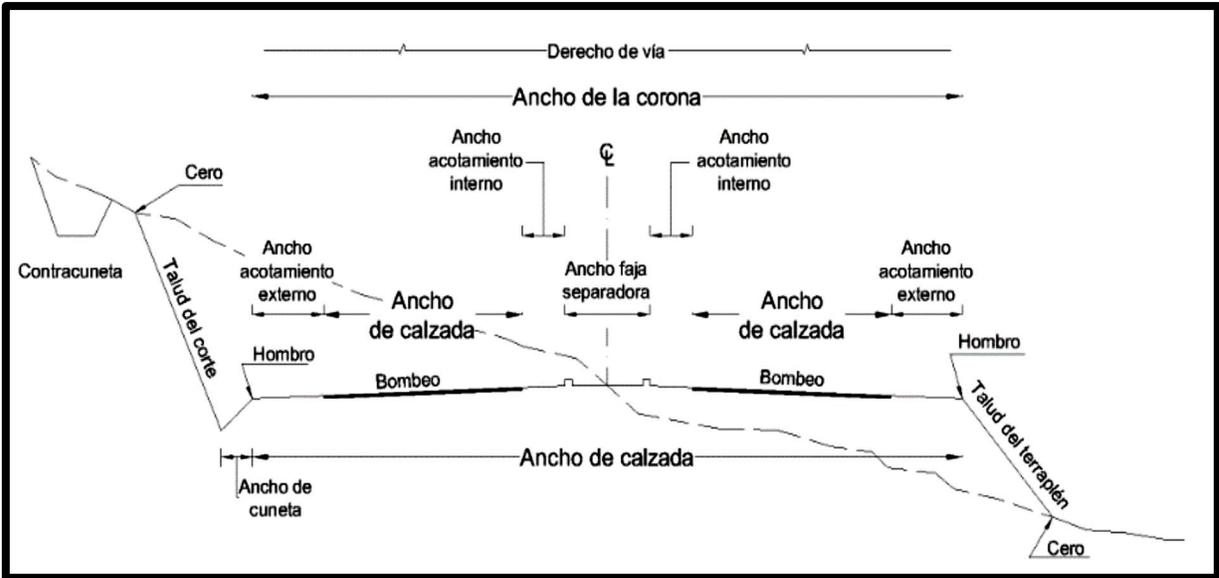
Sección de carretera de cuatro carriles dividida.
